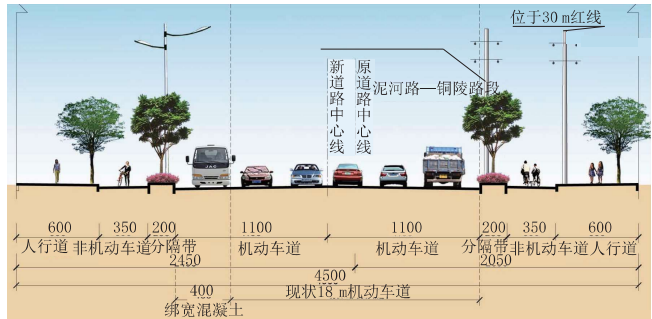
道路横断面布置及单侧加宽示意图(单位:cm)
